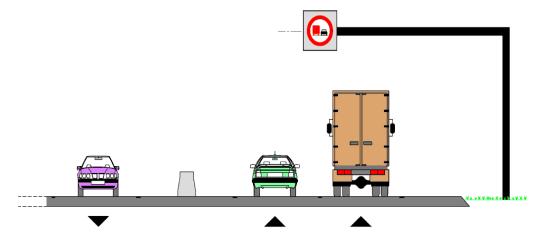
Signalisation de l'interdiction aux poids lourds de dépasser placée au-dessus de la chaussée
